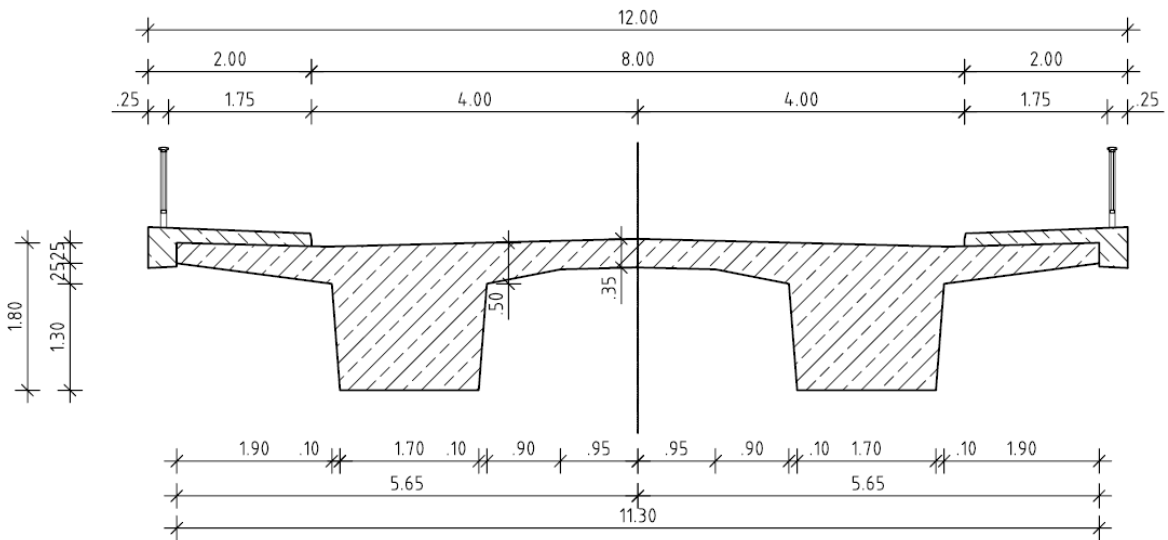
Skizze Plattenbalkenquerschnitt in Massivbauweise mit 8 m Fahrbahnbreite
